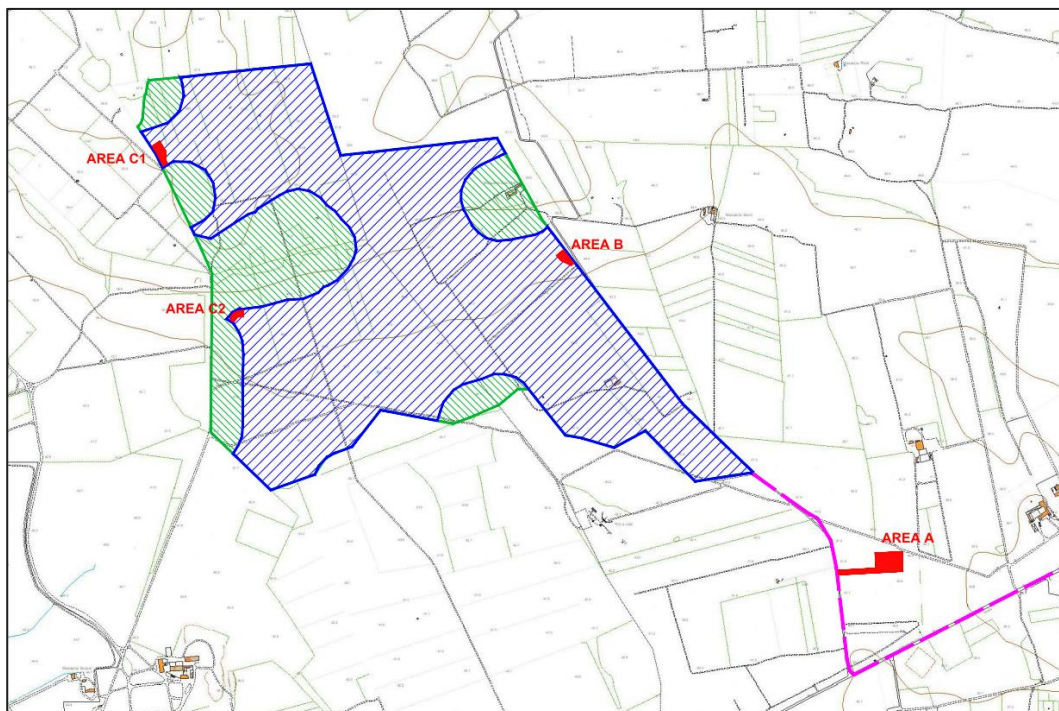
Aree di cantiere di progetto (Fonte: ns elaborazione su CTR)
